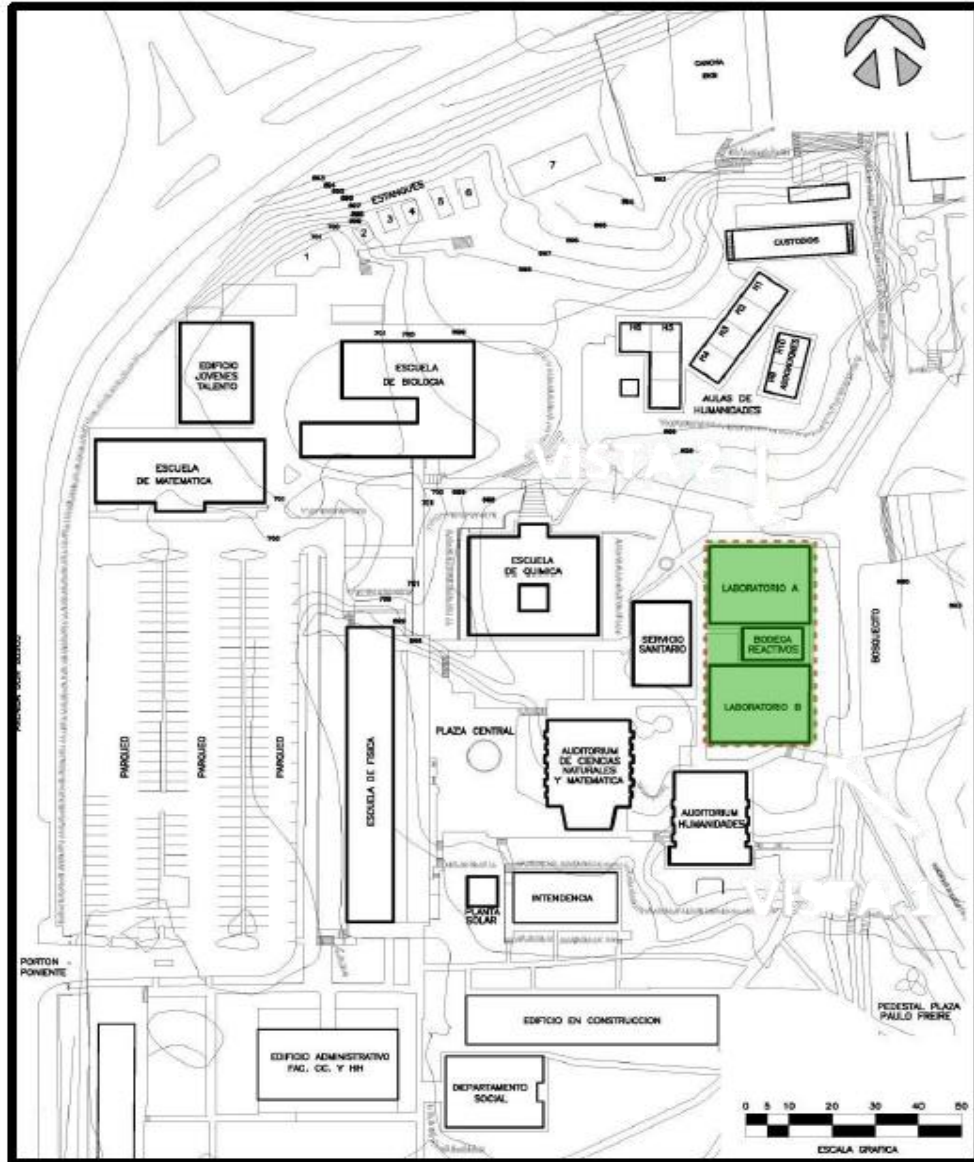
Plano de Ubicación de Terreno Alternativa 2.
